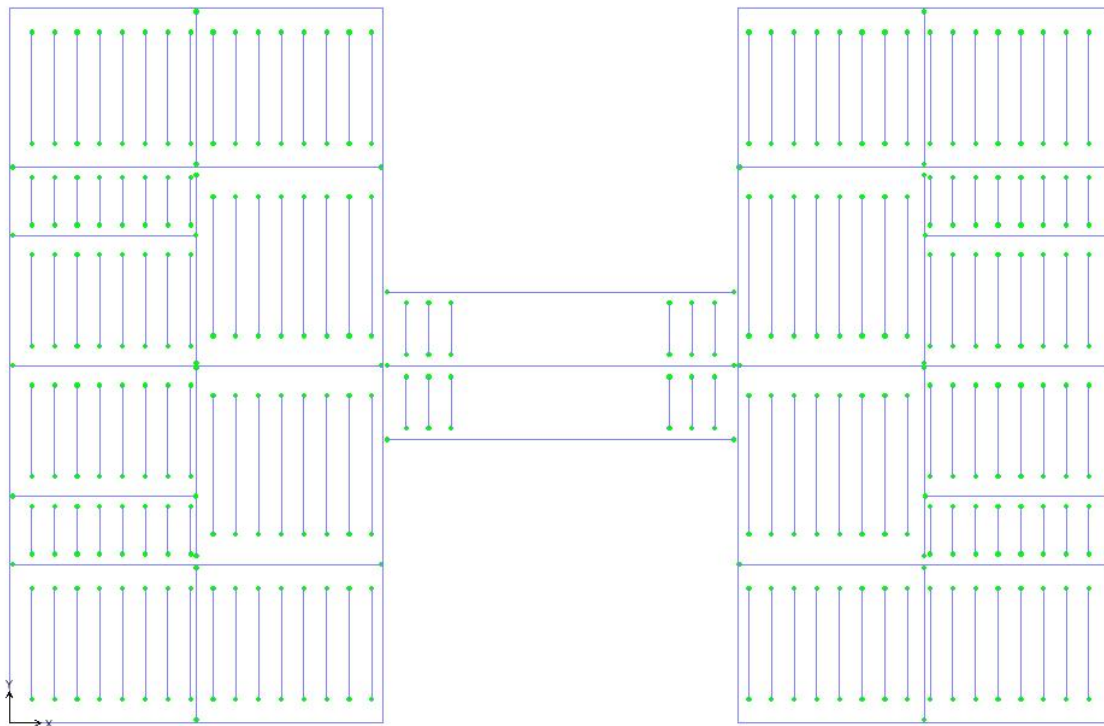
(a) – Esquema estrutural para vigamento bi-apoiado
